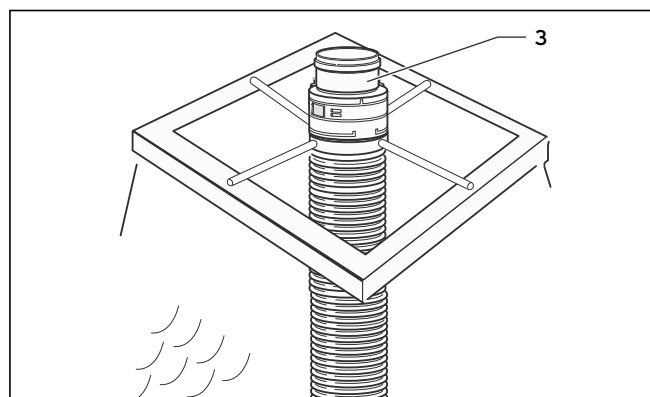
Соединительная деталь с гибким выпускным газопроводом
